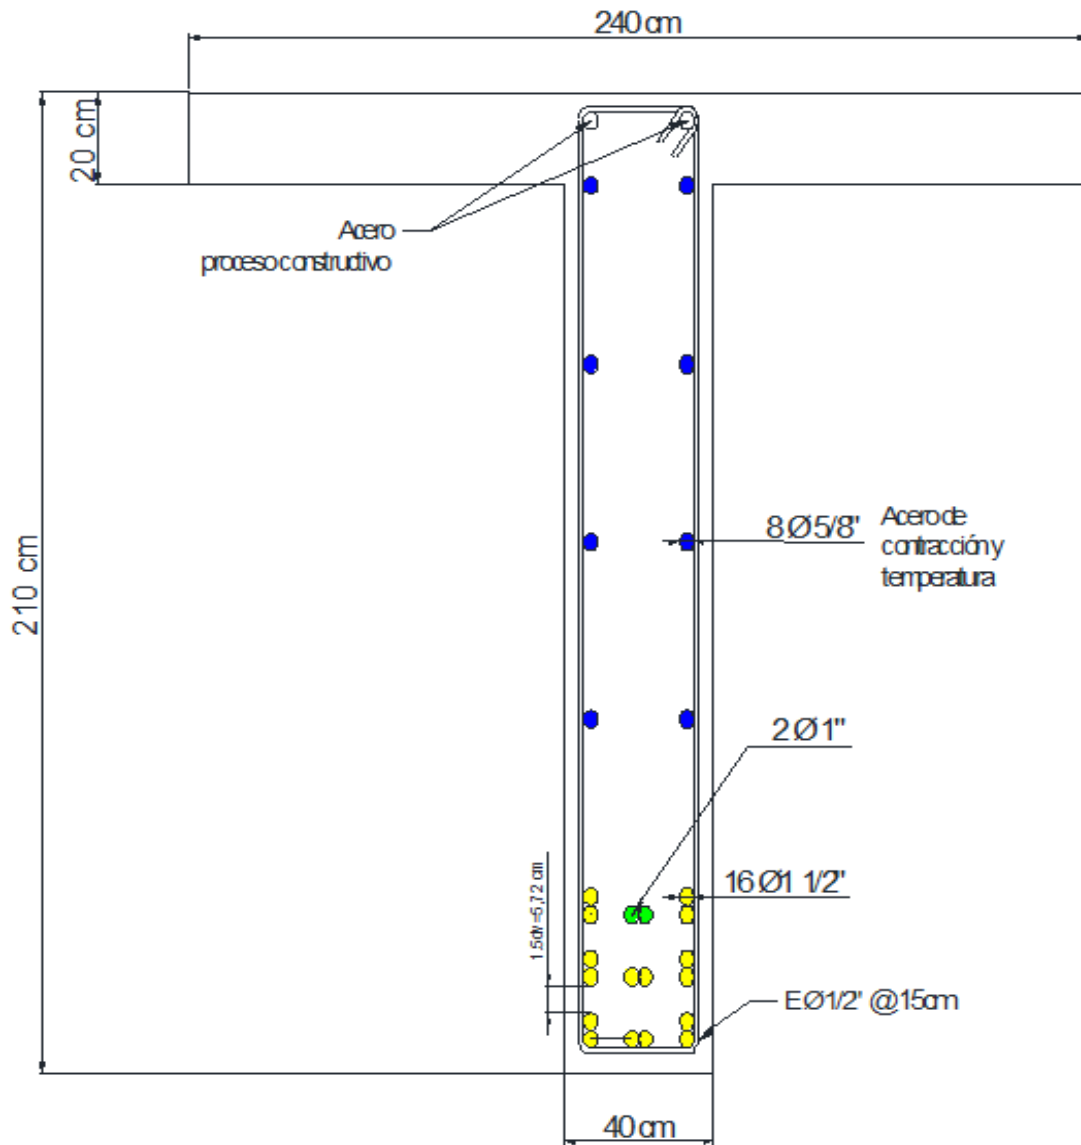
Configuración geométrica y armado estructural de las vigas. Fuente El Autor
